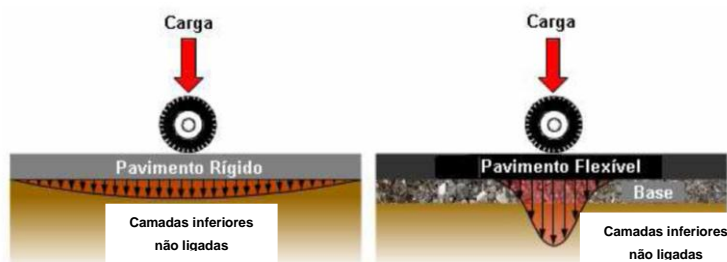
Distribuição de cargas nos pavimentos rígido e flexível [WAPA, 2011].
